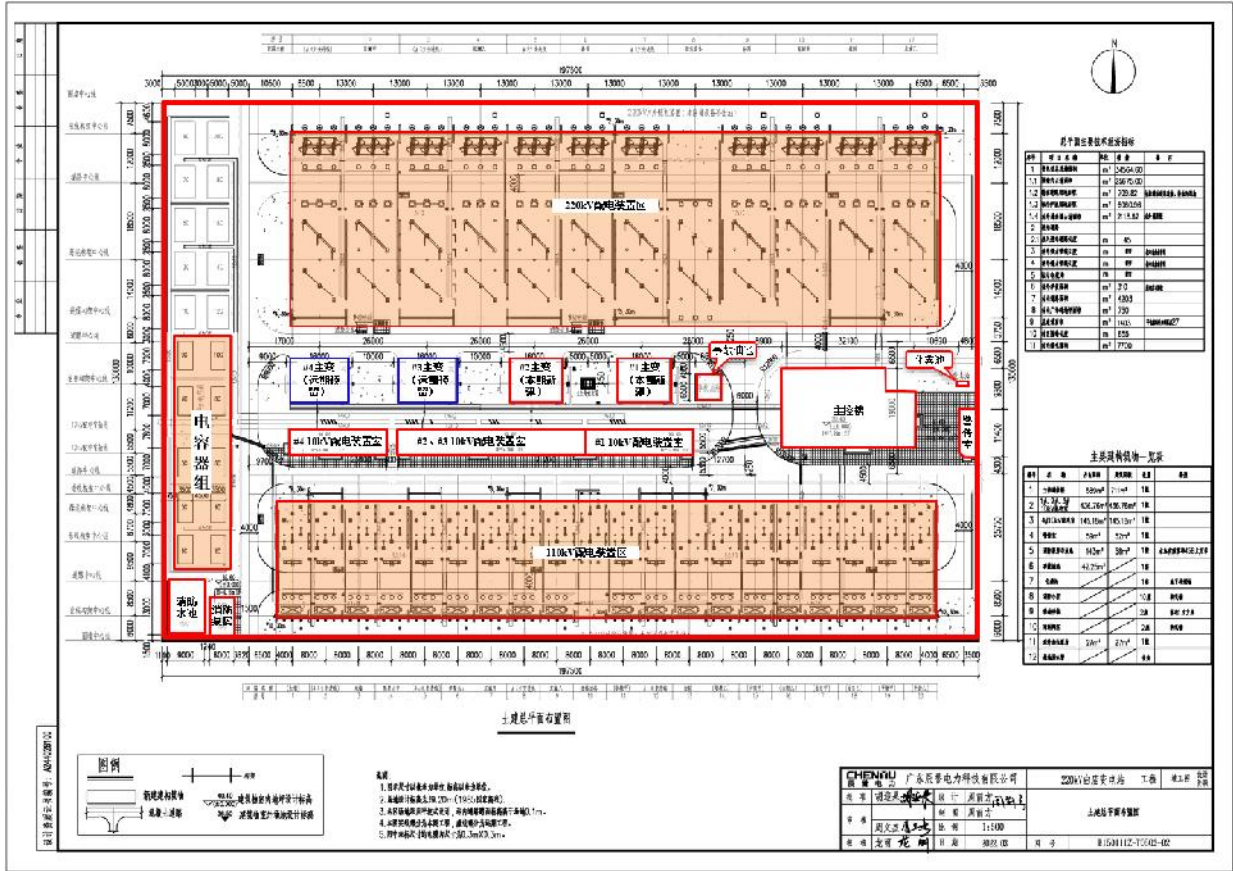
清远 220 千伏白庙（职教城）站总平面布置图
